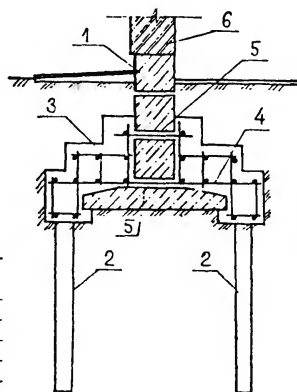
Передача нагрузки от стены на короткие забивные сваи
